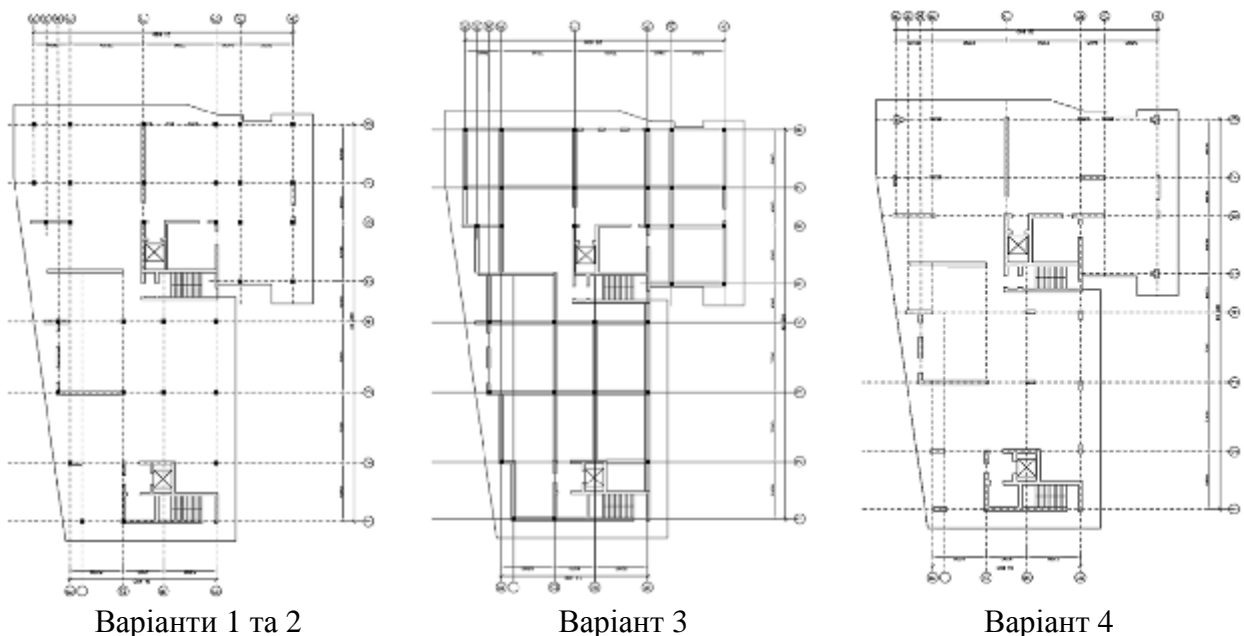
Схеми перекриття типового поверху для варіантів конструктивних схем
